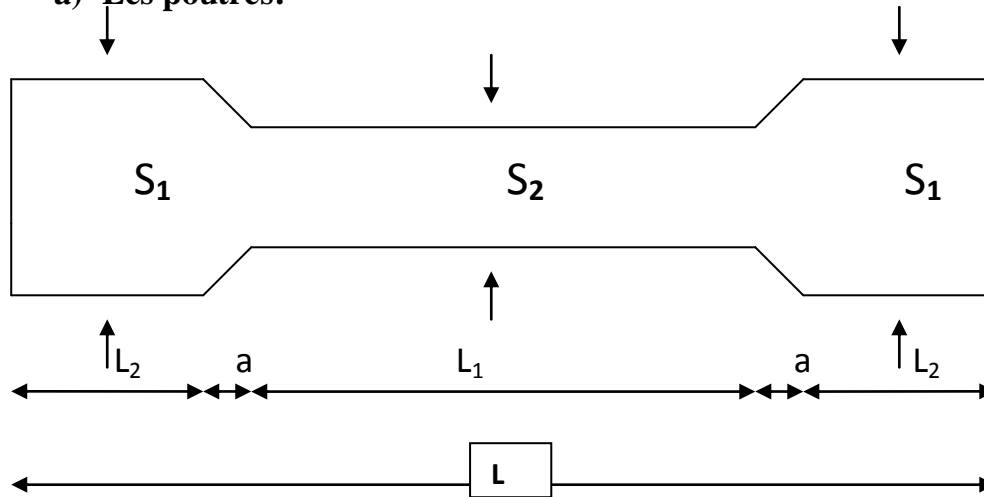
coupe longitudinale de l'âme de la poutre.
